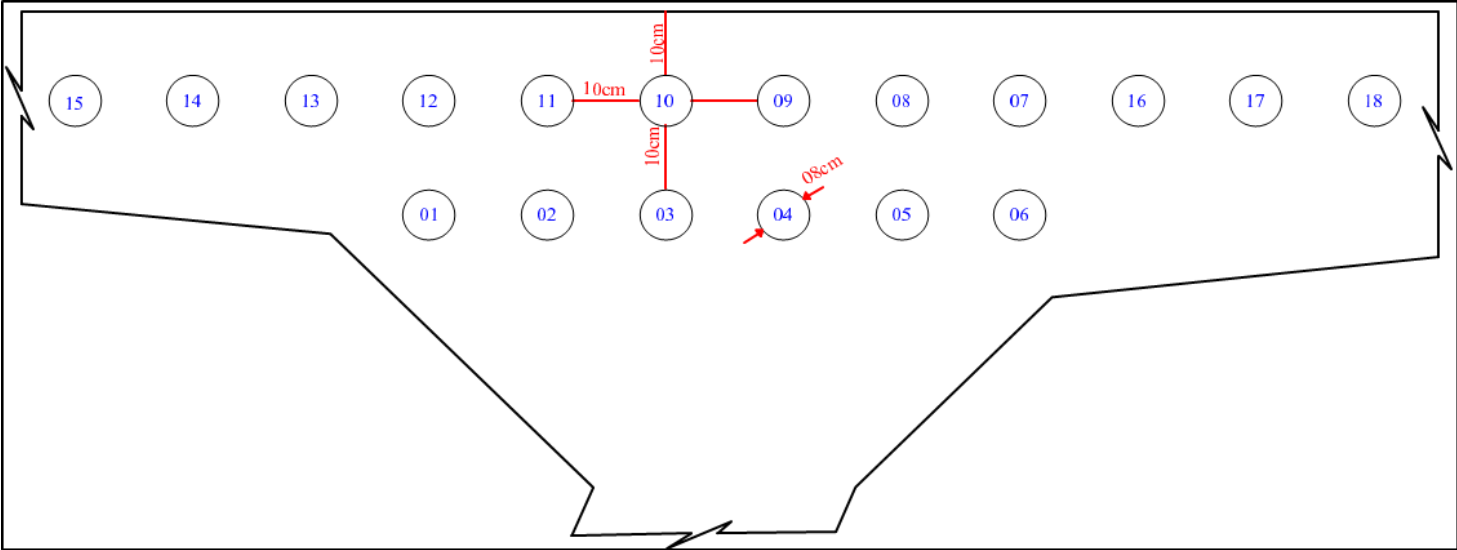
Dispositions des câbles dans le gousset supérieur du voussoir
